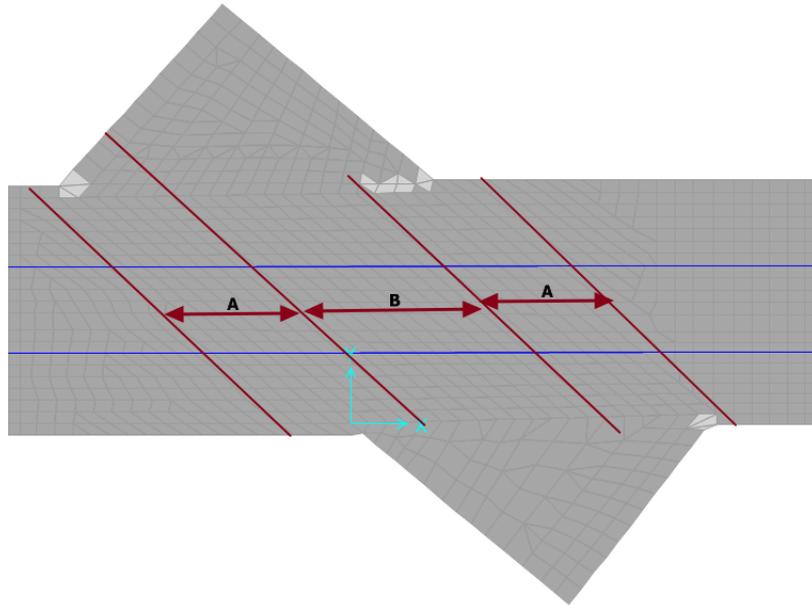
Individuazione dell'infittimento di armatura longitudinale
